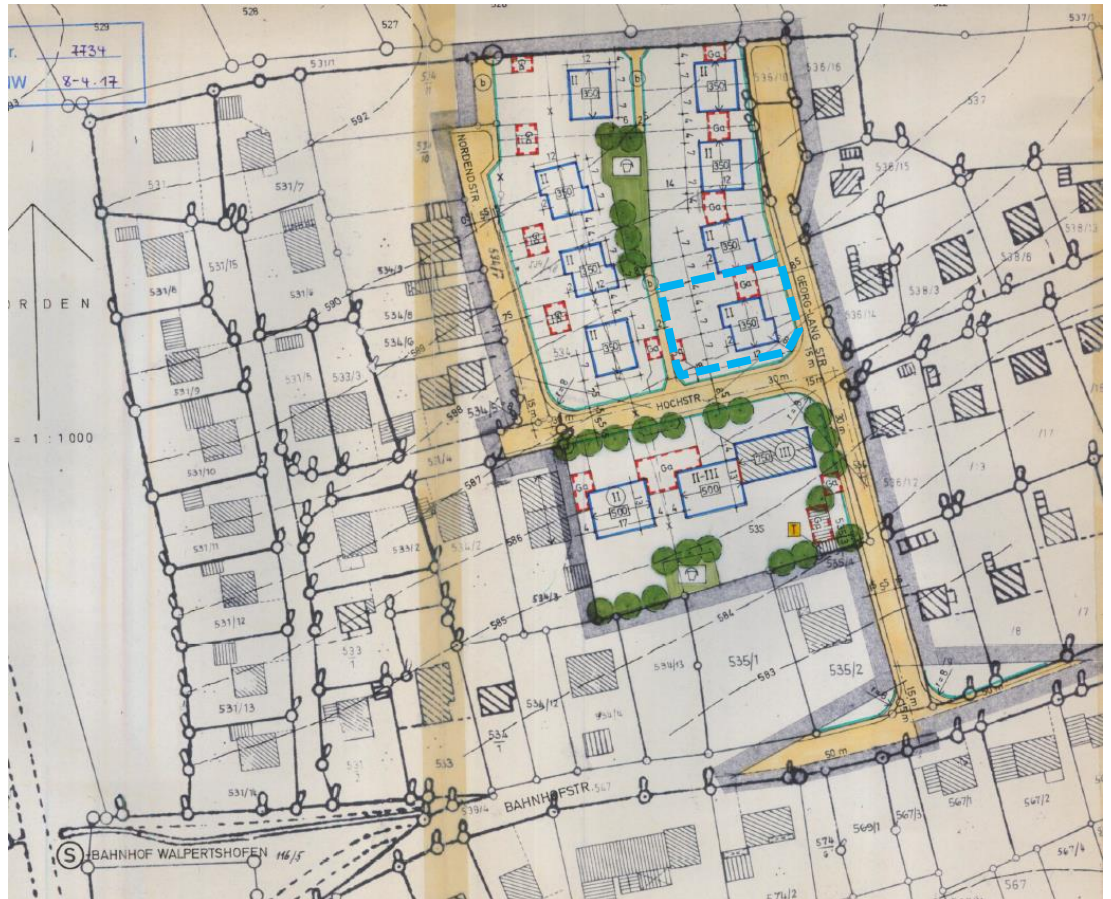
Ausschnitt aus dem Bebauungsplan an der Hoch- und Georg-Lang-Straße, ohne Maßstab, Plangebiet in blau
